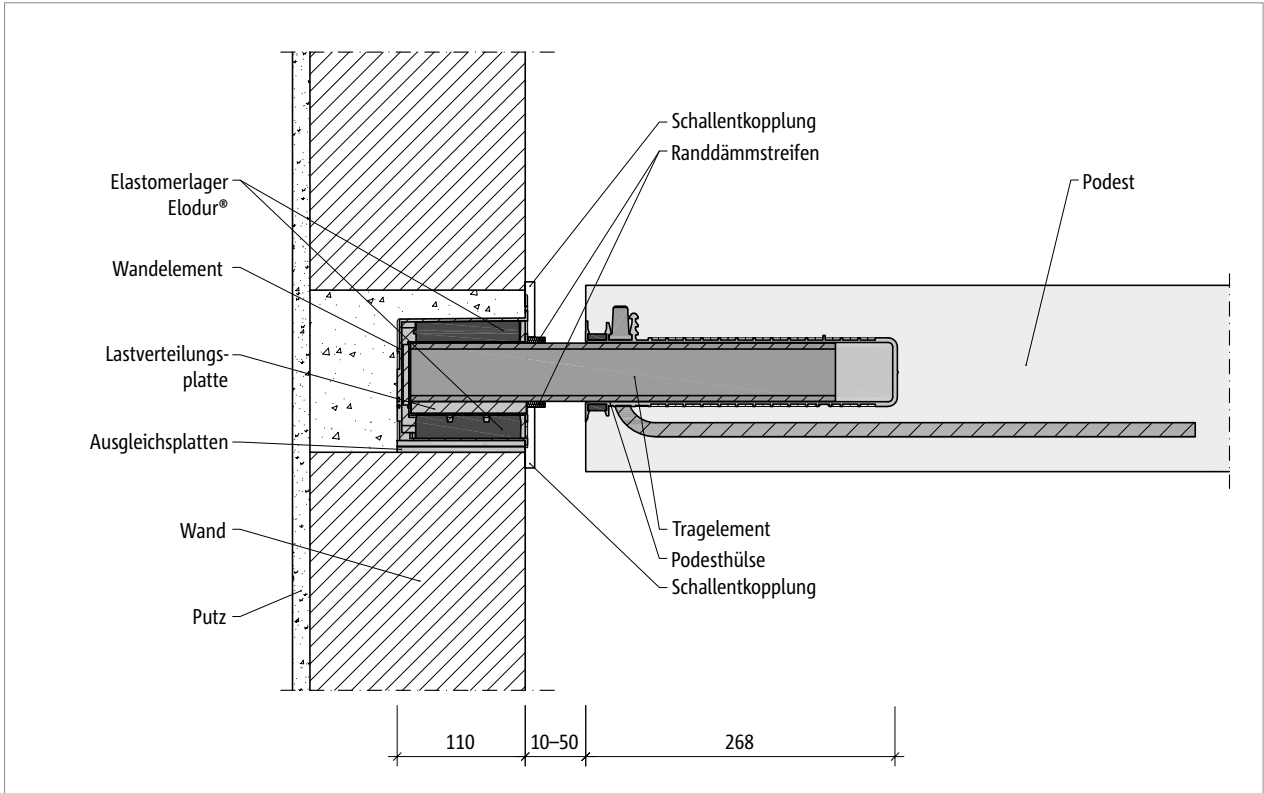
Schöck Tronsole® Typ P: Einbauschnitt mit Elementpodest und Luftfuge
